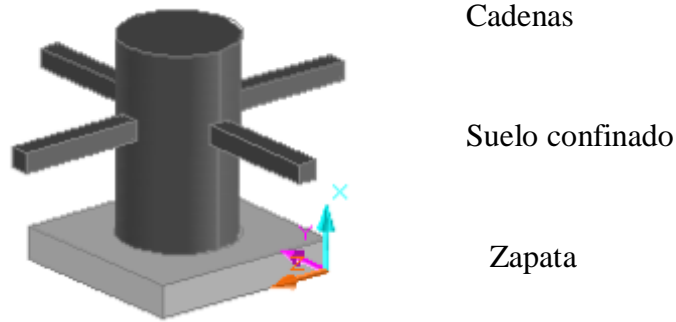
Esquema real de la cimentación con zapatas aisladas.
